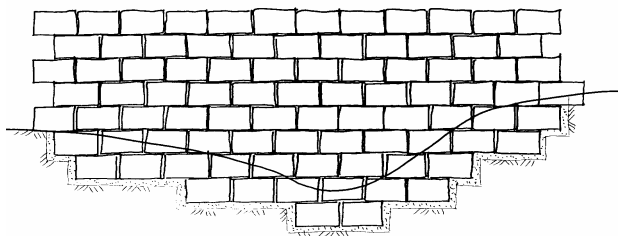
Vista frontal do terreno natural e da base do muro em camadas niveladas.
